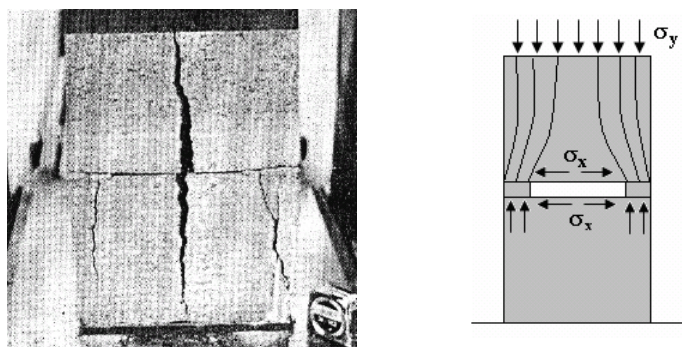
Modo de ruptura e mecanismo gerador de tensões horizontais em prismas de blocos de concreto, com argamassamento nas faces longitudinais (MOHAMAD, 2007)
